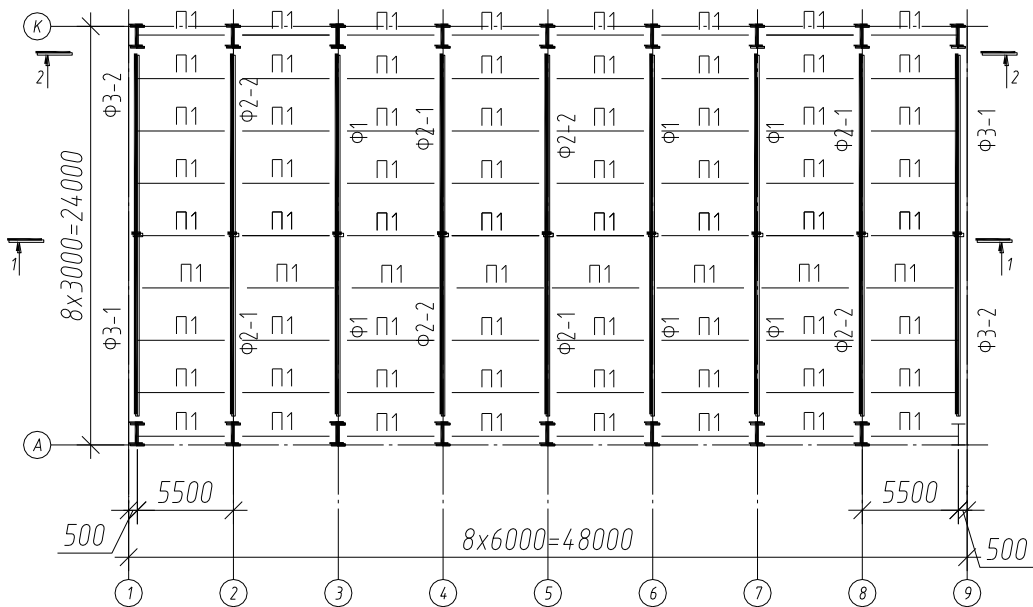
Схема расположения прогонов по верхним поясам ферм
